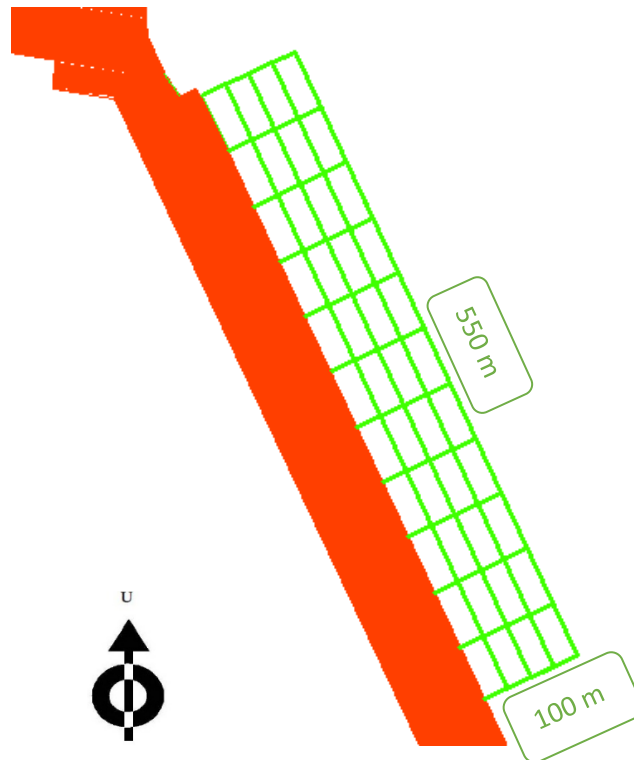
kolam labuh baru dan *slope* skenario 1
